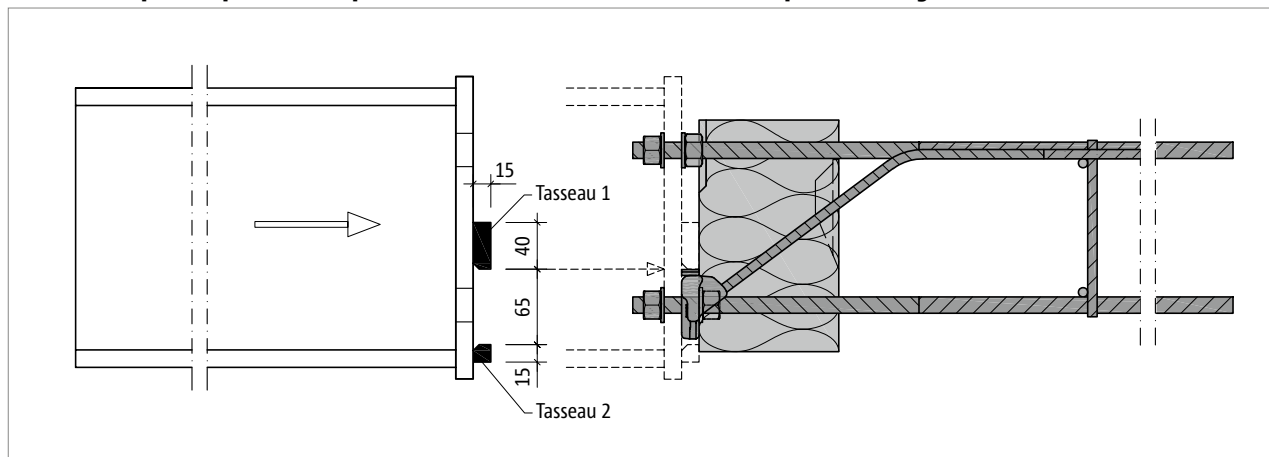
Schöck Isokorb® XT type SK : montage de la poutre en acier
